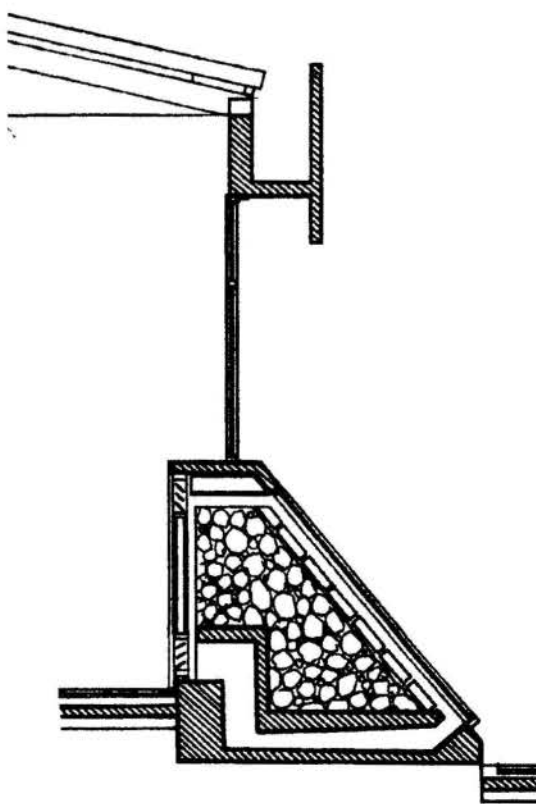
Fachada norte do prédio com o coletor solar acumulador de calor
